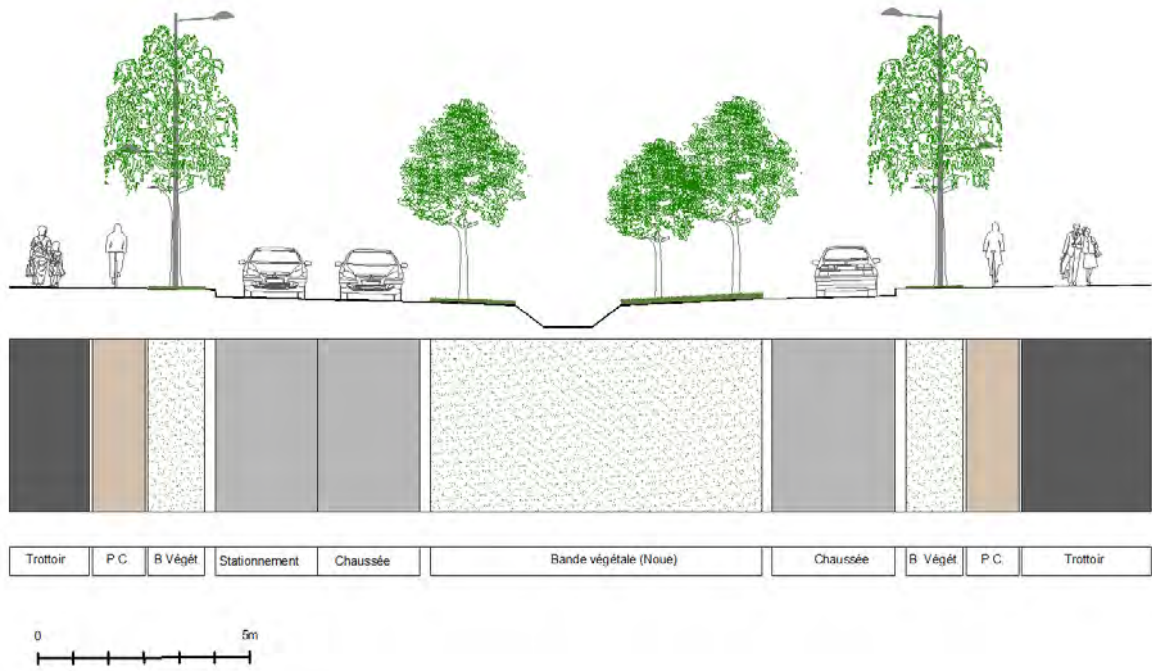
Coupe de principe section 1 du Boulevard de la Vauve
